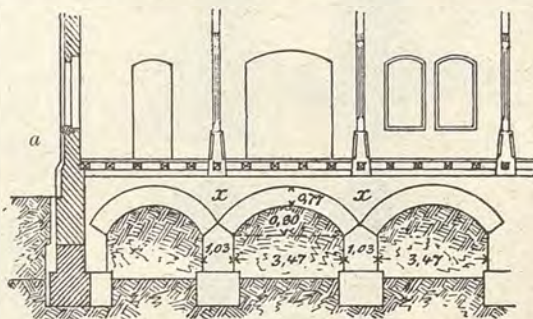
a, b. — Fondazione a pilastri e archi.
